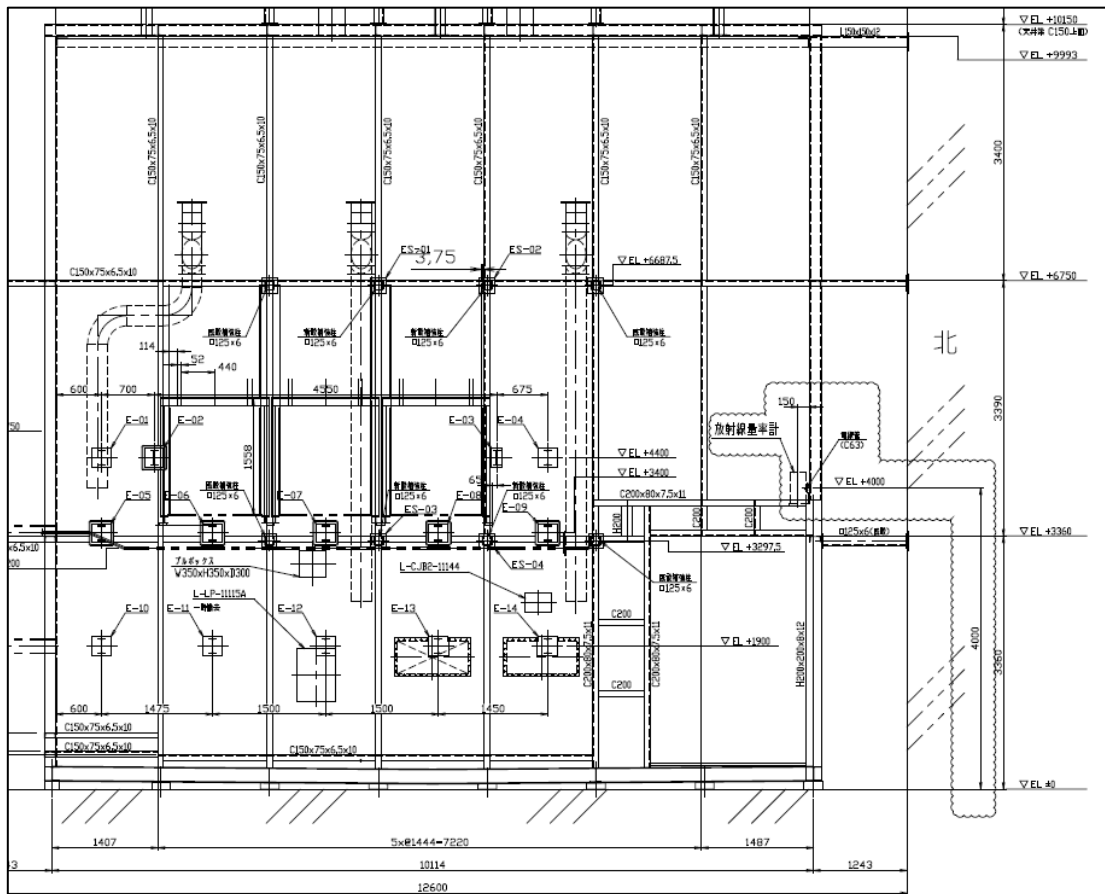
A1-2 炉室 (S) 立面図 (東面)
